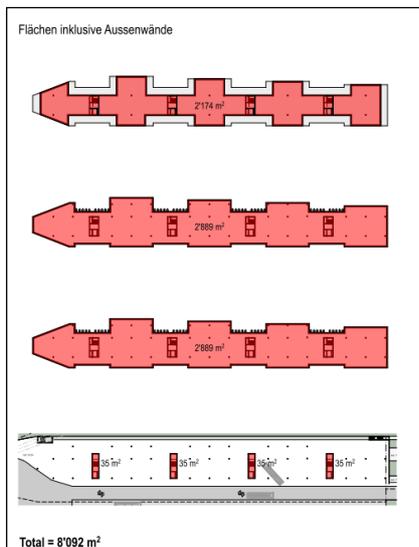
/ 5 Flächenberechnung [5] und Plan Untergeschosse Parking [6] Gestaltungsplan 31.10.2019
